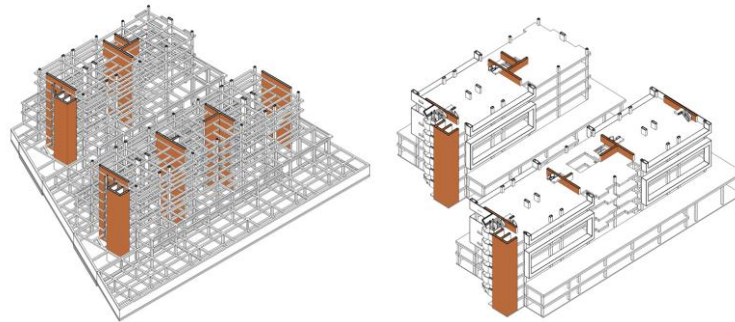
Se observa en la ilustración de la izquierda el sistema estructural dual y en la derecha el principio estructura de la propuesta arquitectónica (zona industrial)
